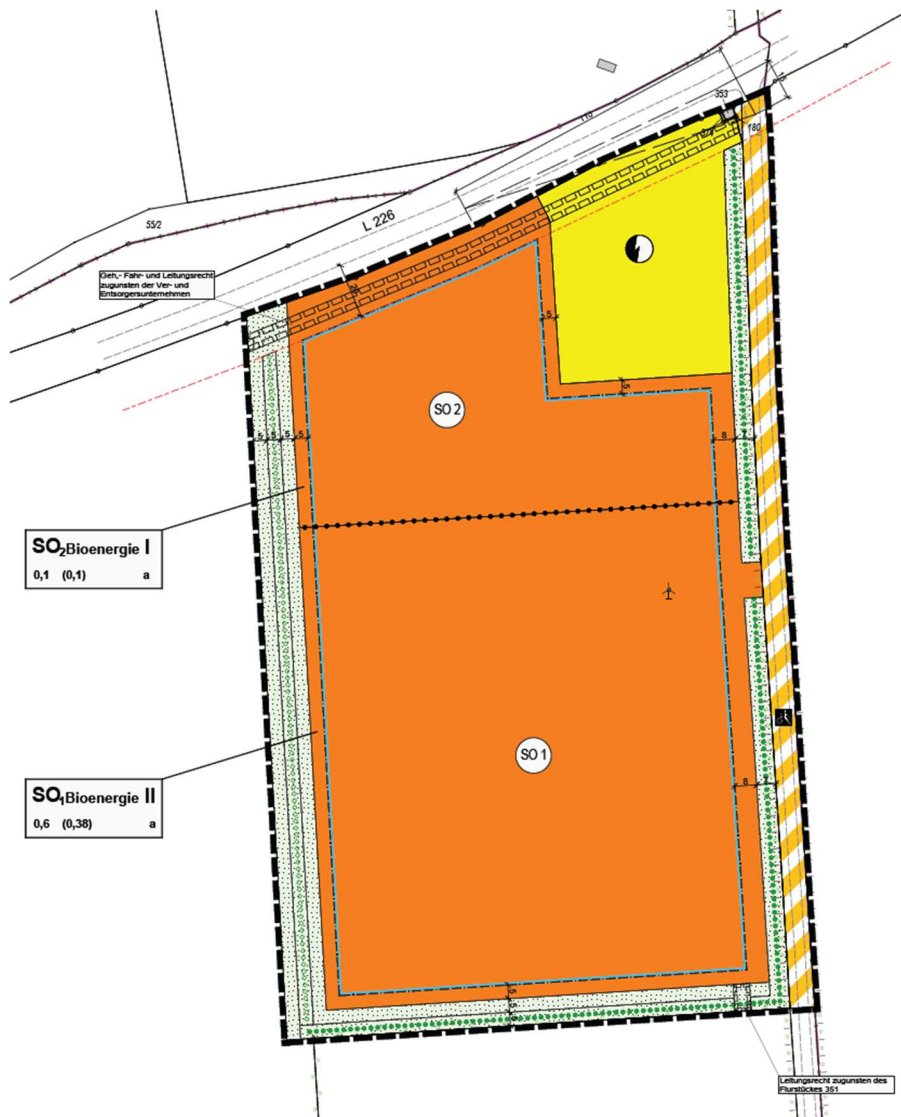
Planentwurf Bebauungsplan Nr. 130 mit Stand vom 09.02.2026
